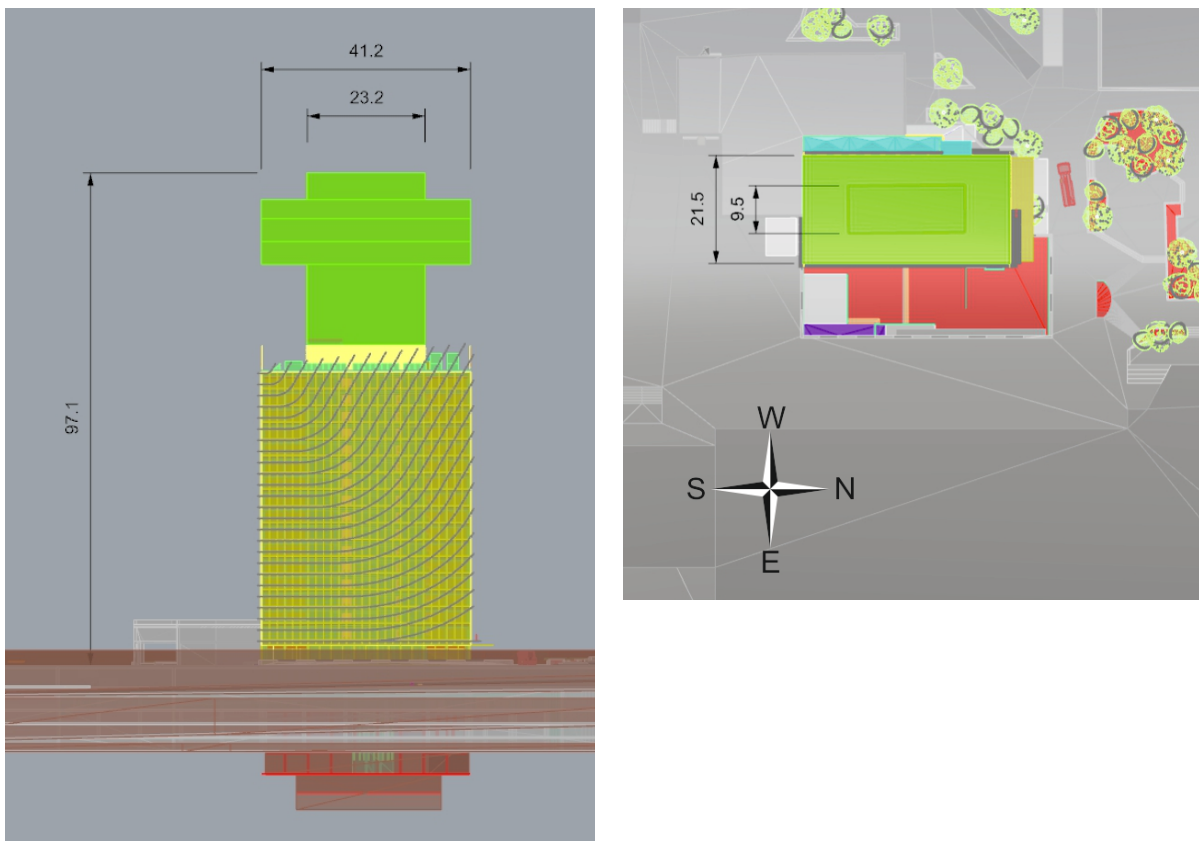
Vista en alzado desde la fachada este y planta del edificio (cotas en metros).
